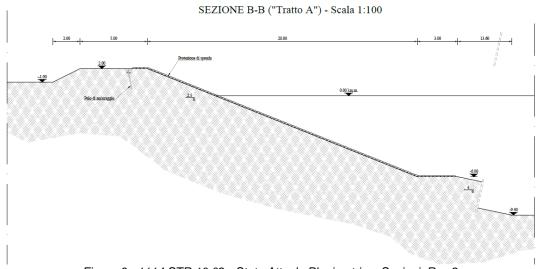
1114.STR.10.02 - Stato Attuale Planimetria e Sezioni\_Rev.2
